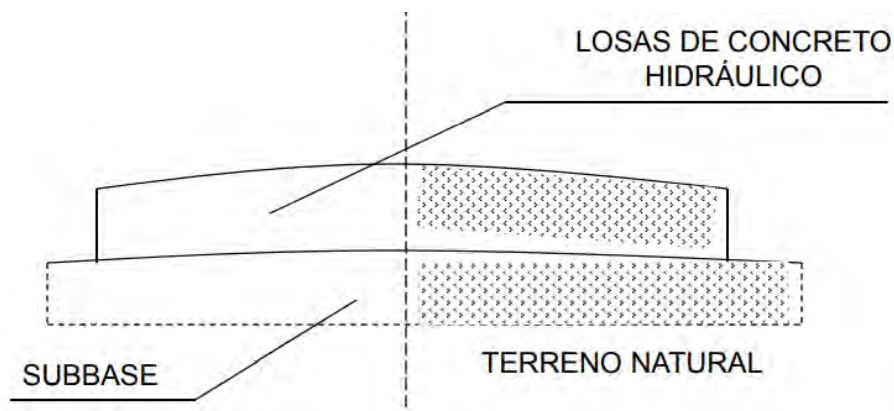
Esquema general de un pavimento rígido (Reyes R. R., 2020).
